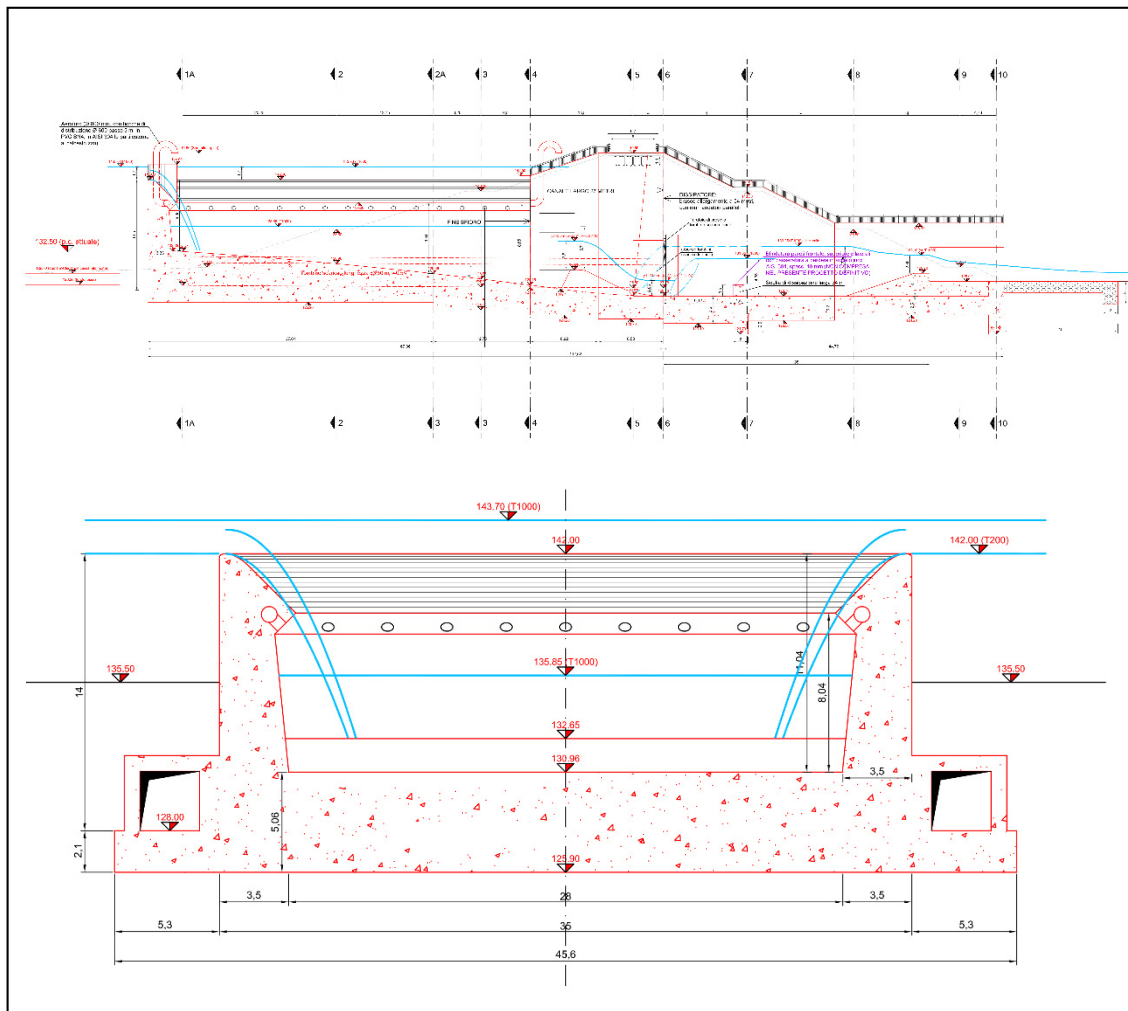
Profilo longitudinale e sezione trasversale (Sez. 2) del manufatto C.
